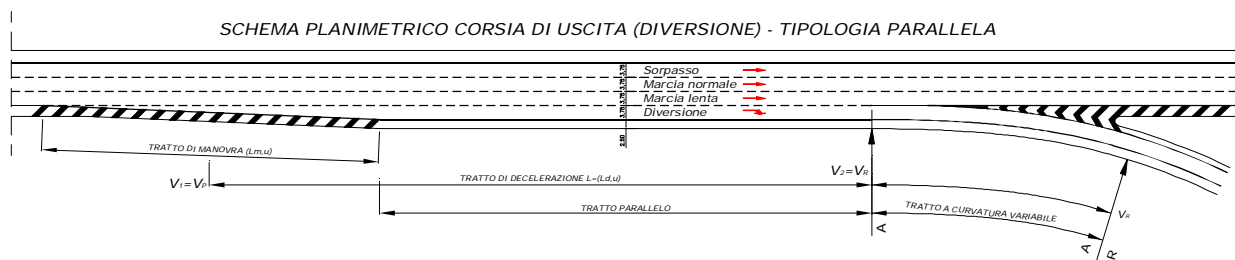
Schema planimetrico corsia di uscita (diversione) - tipologia parallela
